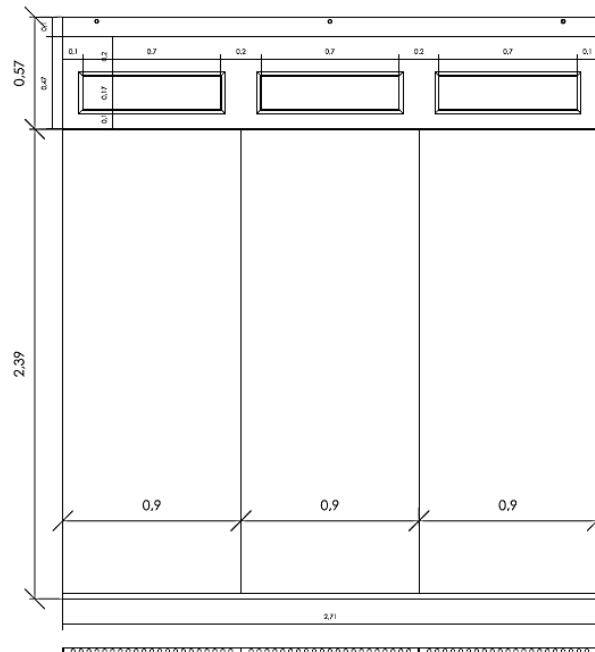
Diseño y montaje de la hoja exterior en la muestra de fachada forzada
